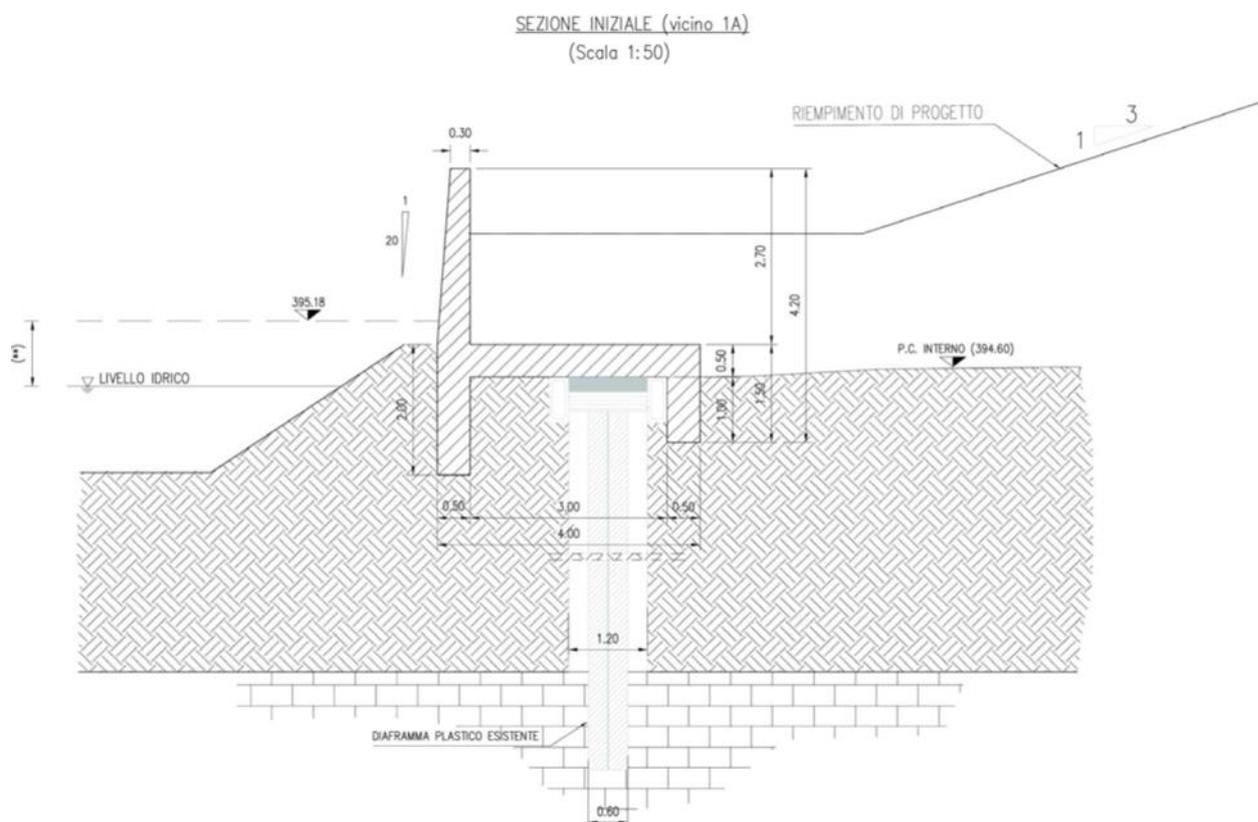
Sezione tipo della dell'opera di confinamento arginale – Tipologia 0
